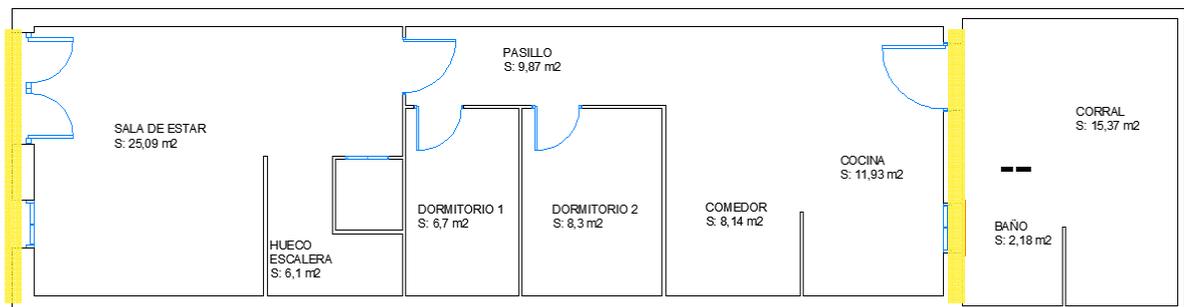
Se señalan en el plano las dos fachadas de la vivienda
